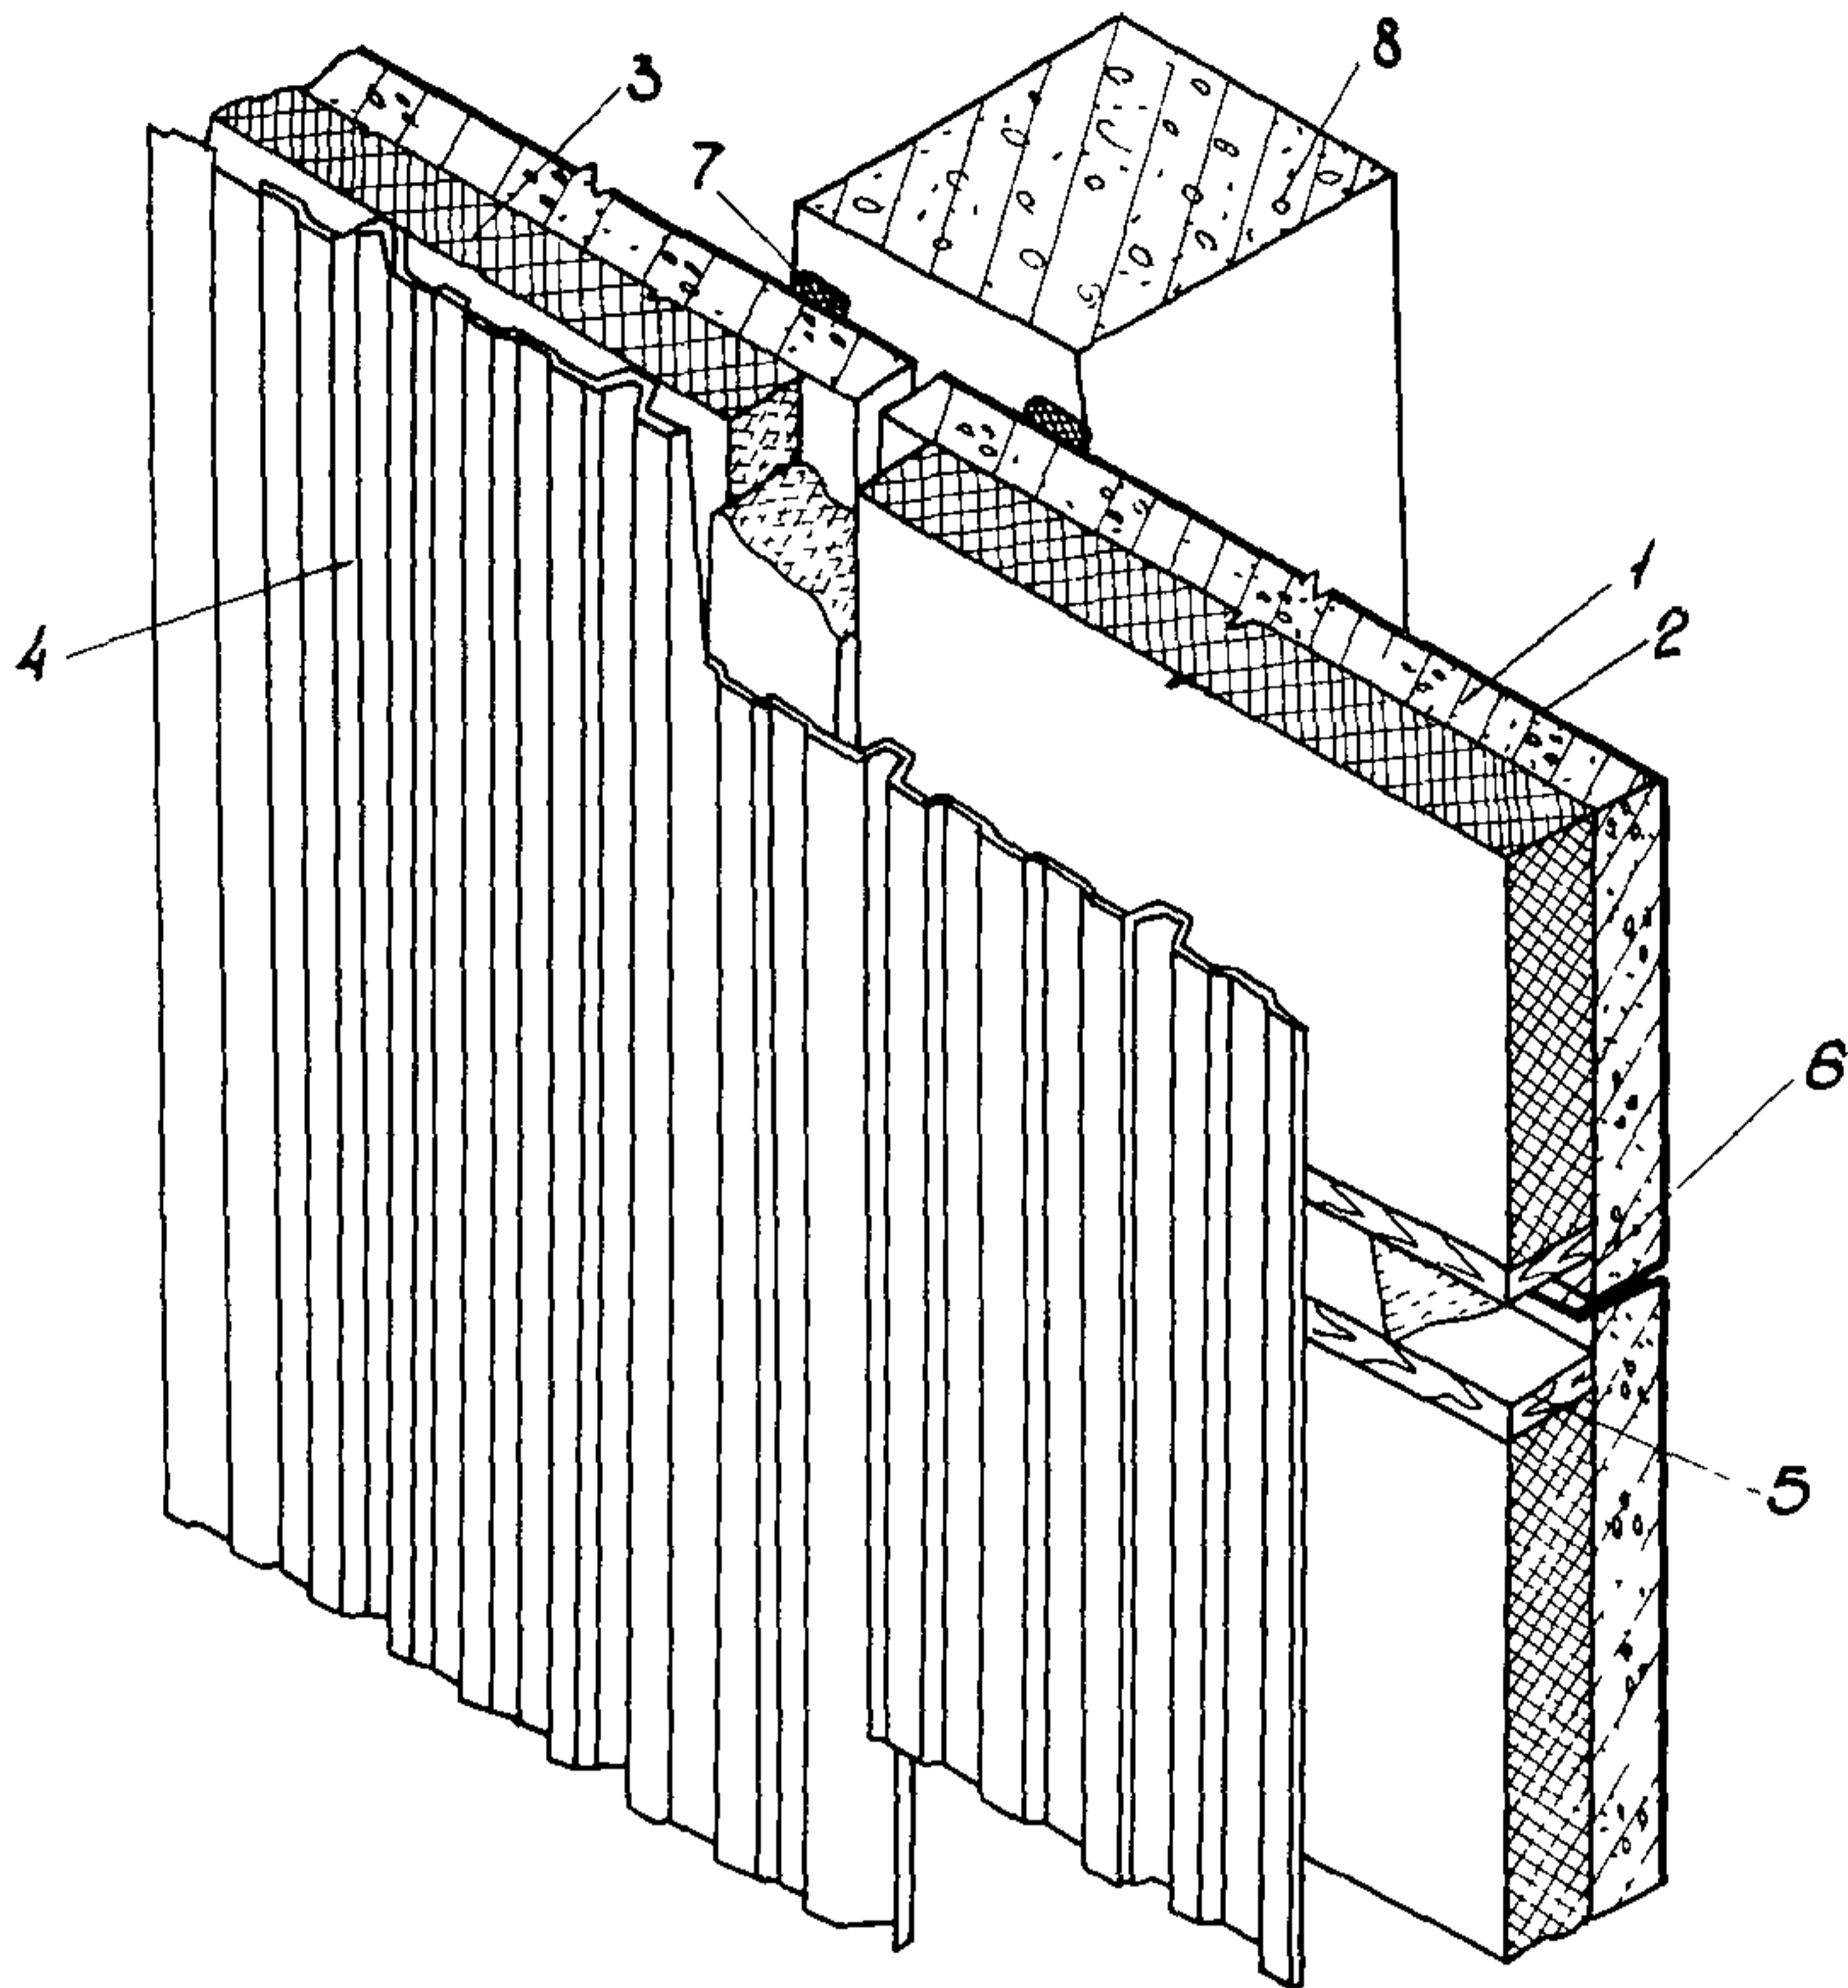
Фрагмент стены из трехслойных железобетонных панелей с полиэтиленовым покрытием
